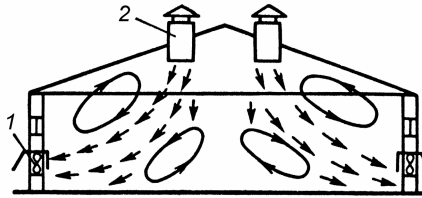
Витяжна вентиляція з настінними вентиляторами:
